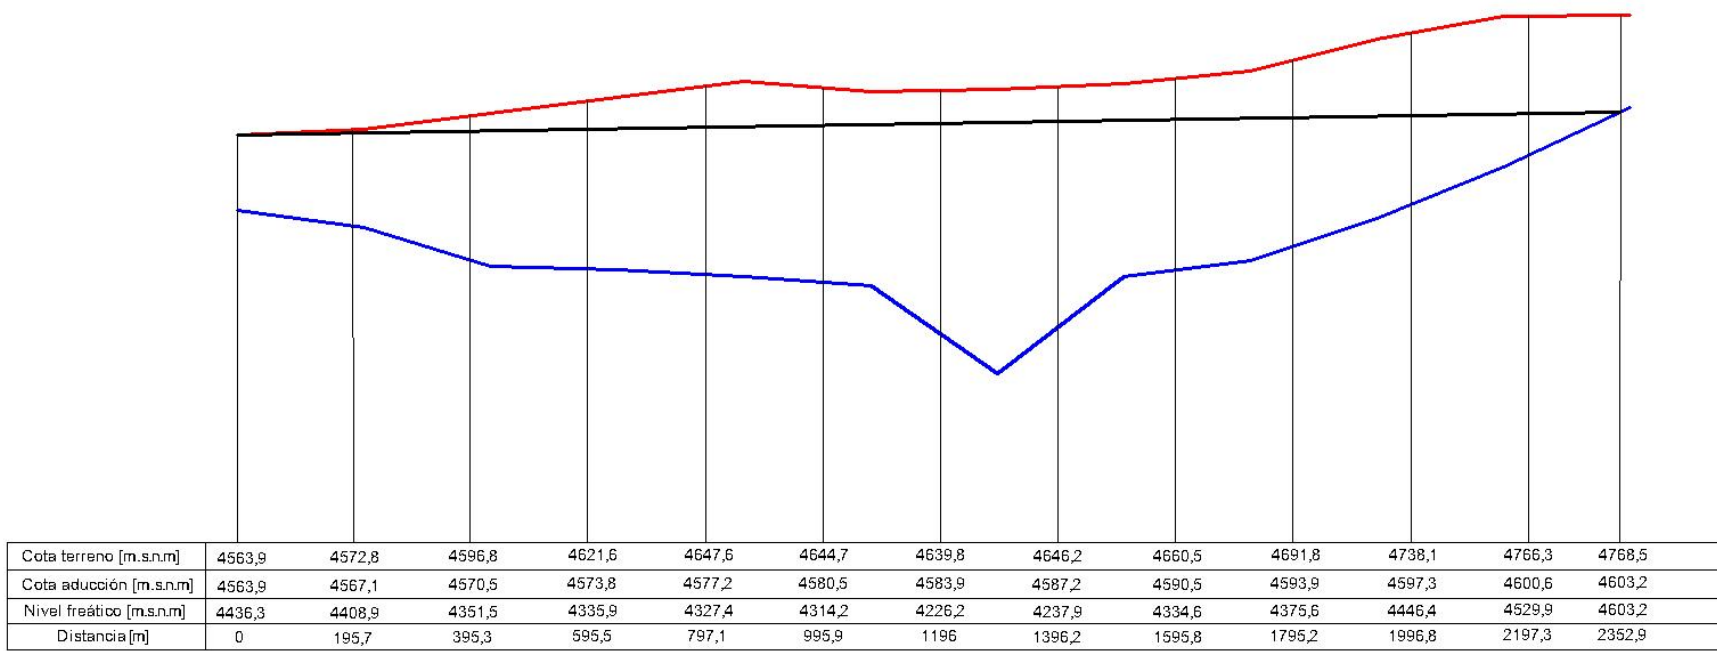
Perfil longitudinal de aducción en Quebrada 8.
